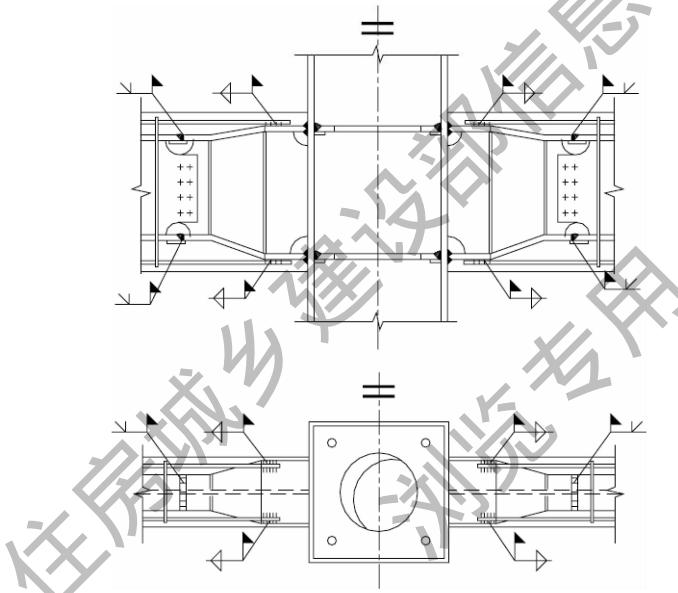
型钢混凝土梁与矩形钢管混凝土柱连接节点示意
